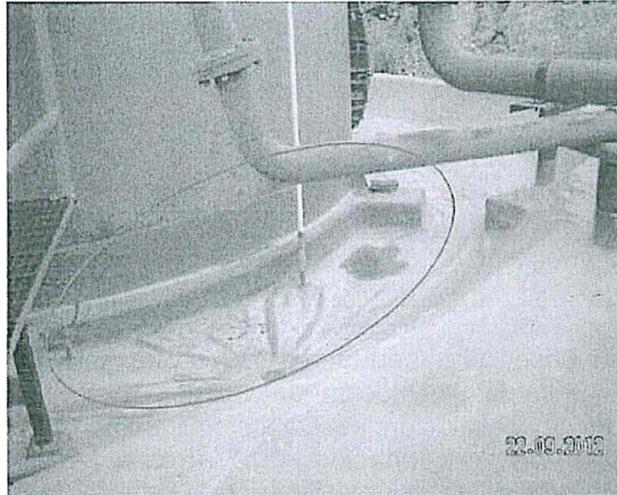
Vista del Sludge Tank con la poza de contingencia impermeabilizada con geomembrana y con diseño mejorado (Cumplimiento de recomendación N° 2 del 2011)
